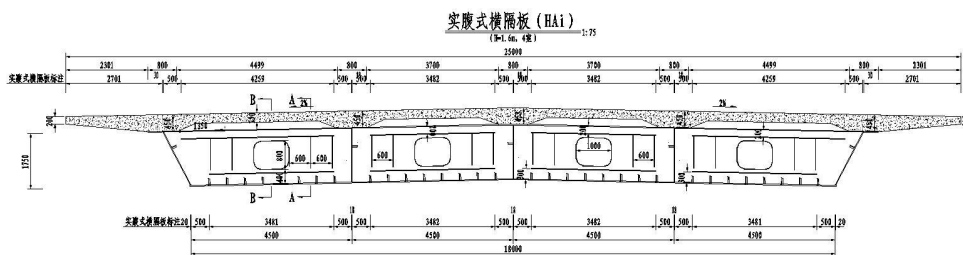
组合梁实腹式横隔板处横断面图 (单位: mm)
